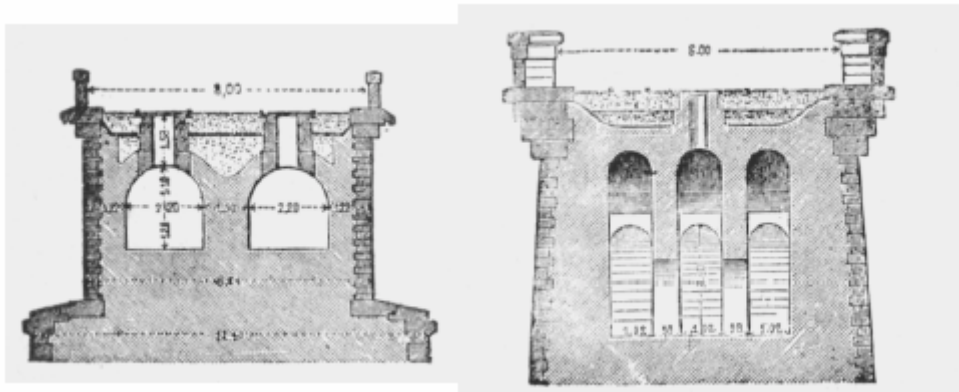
Sección transversal de un puente obra de fábrica: aligeramiento longitudinal en forma de bovedillas en el interior del relleno [6].
